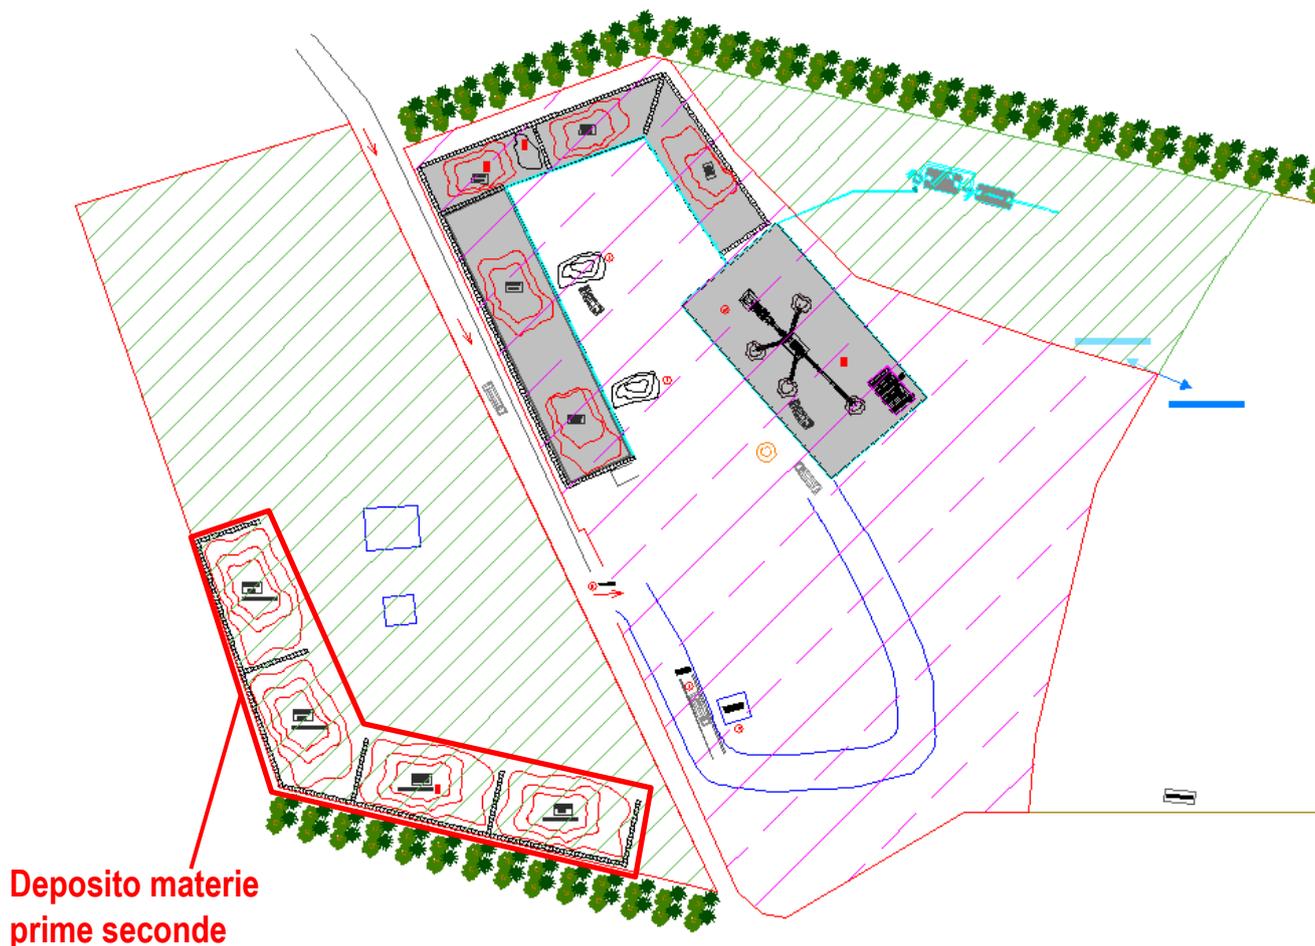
Planimetria impianto con zonizzazione PRG Comune Sant'Elpidio a Mare
